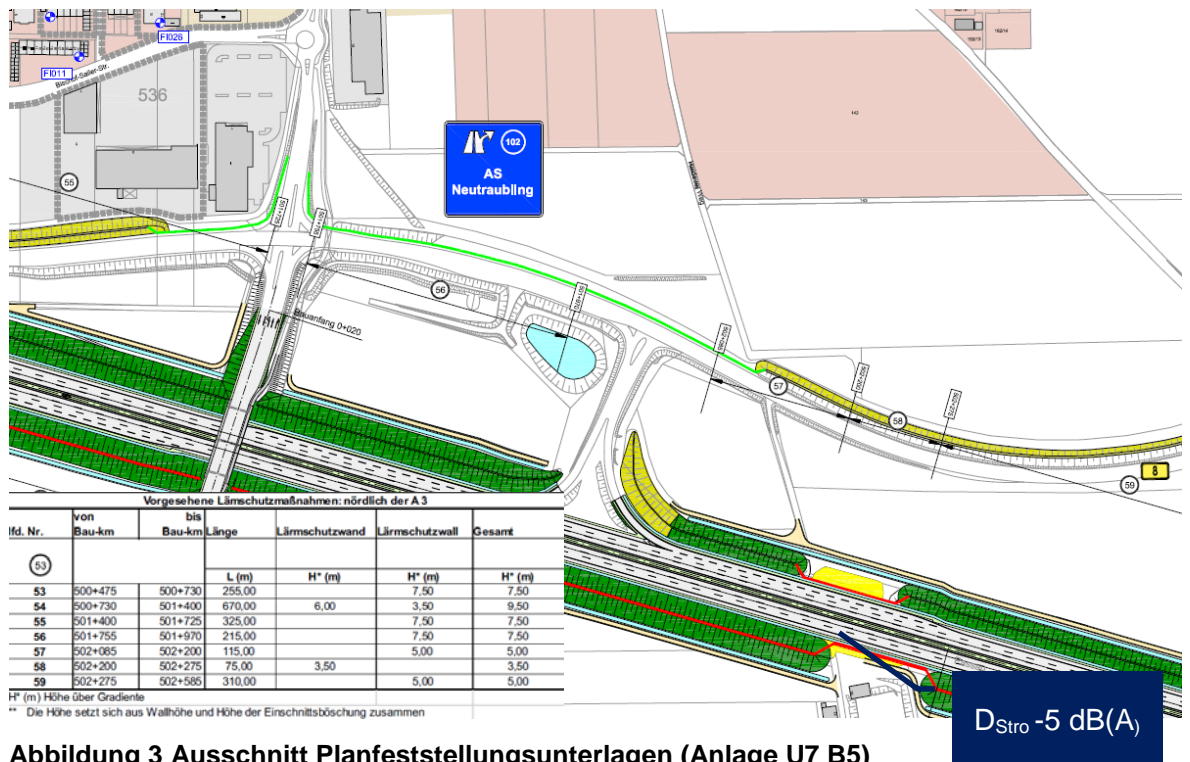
Ausschnitt Planfeststellungsunterlagen (Anlage U7 B5)
